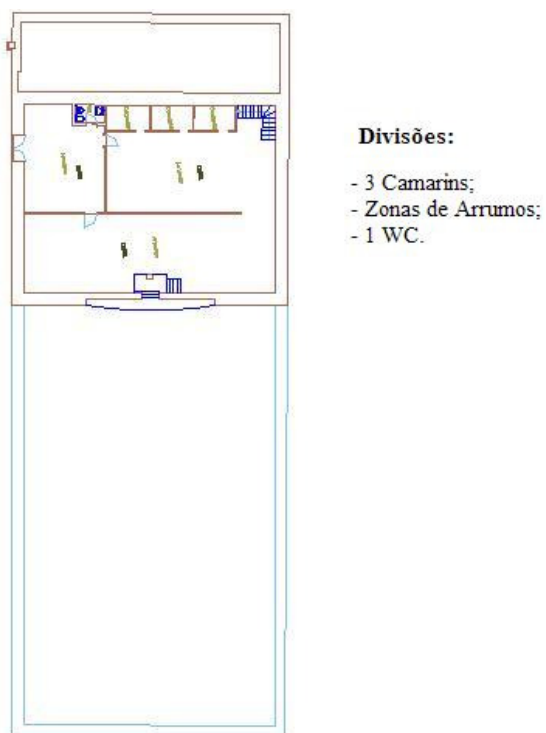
Planta do piso 1 do edifício e respectivas divisões.
